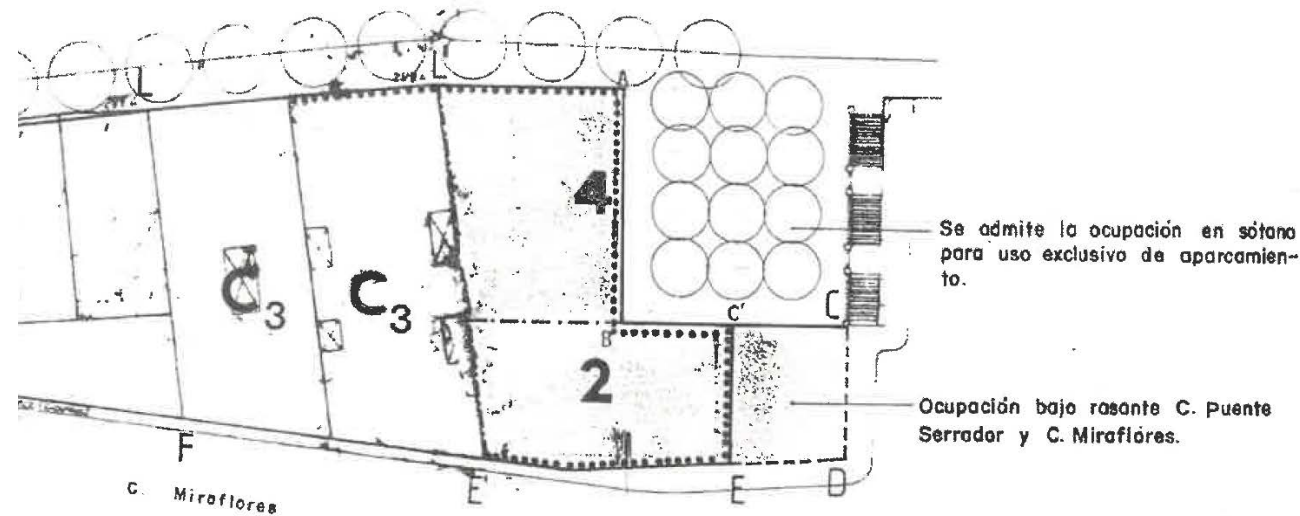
Imagen parcial del plano de ordenación recogida en la Ficha de Ordenación Detallada
